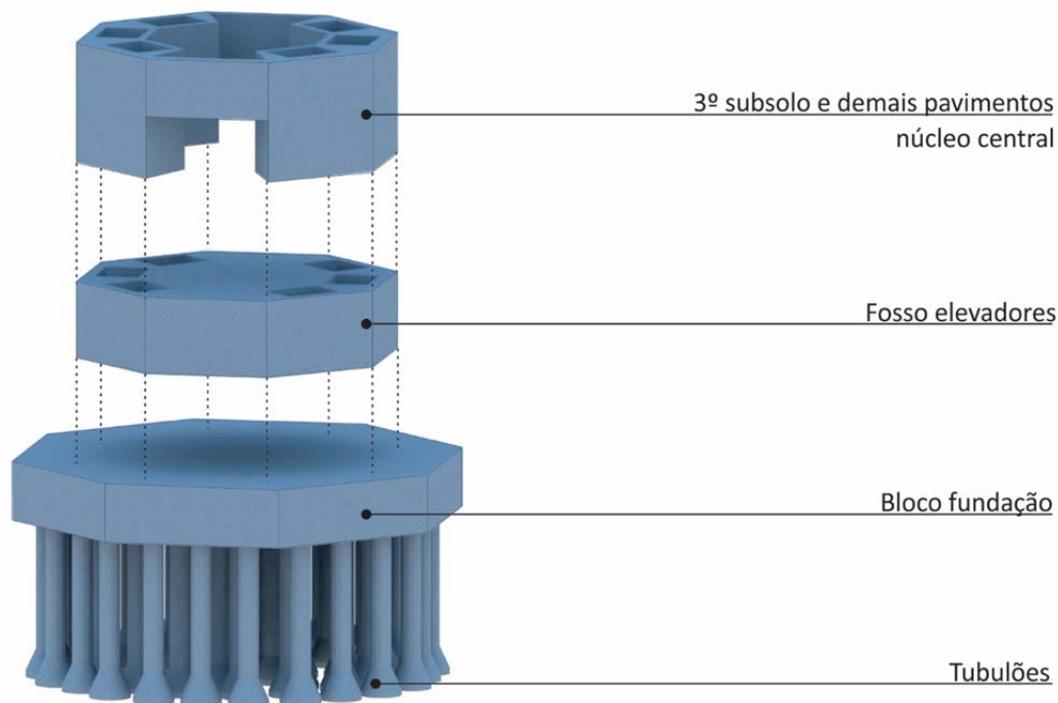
Esquema estrutural da fundação da torre da sede Banco Safra
